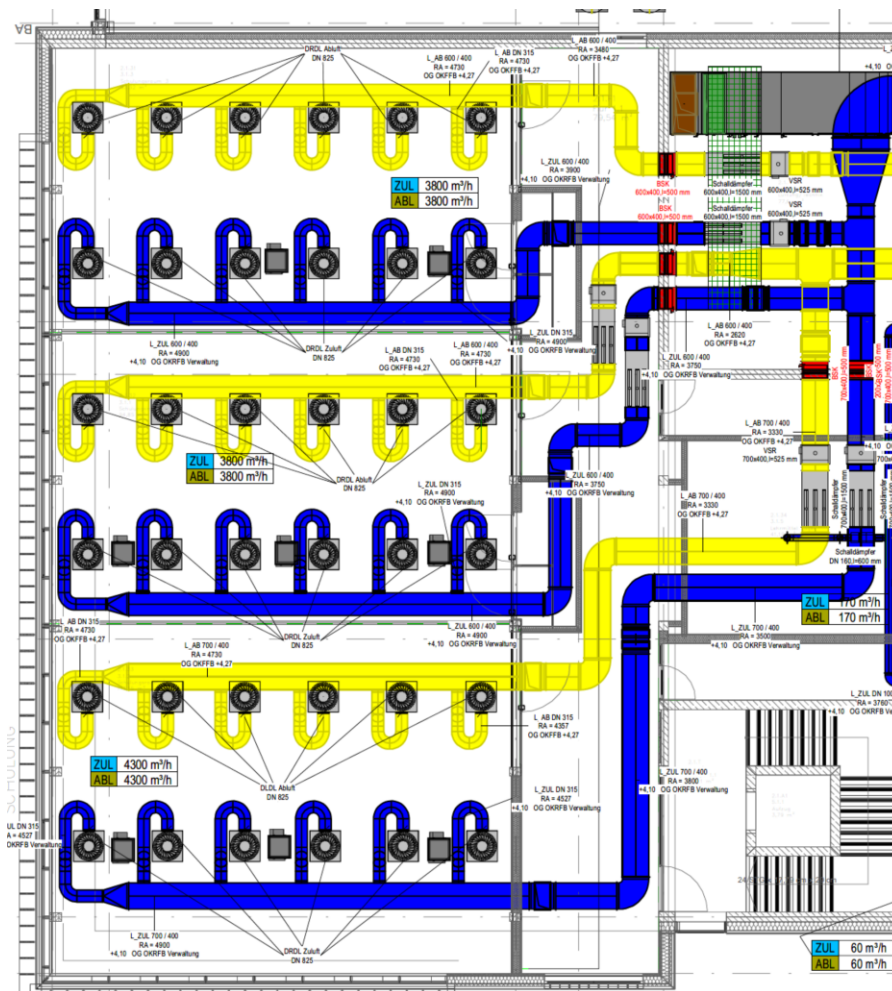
Grundrissausschnitt mit Lüftungsplanung Schulungsräume
